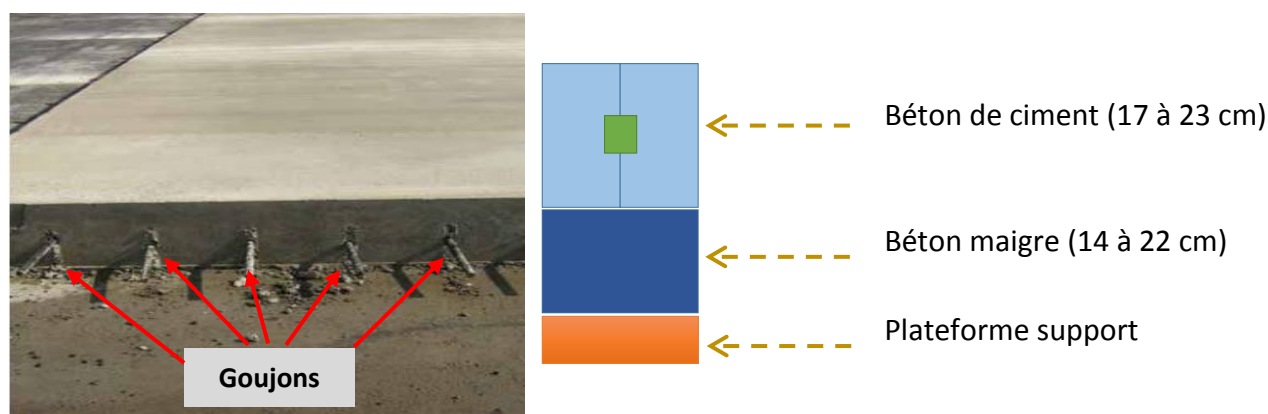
Chaussées à dalles non armées et à joints goudonnées
